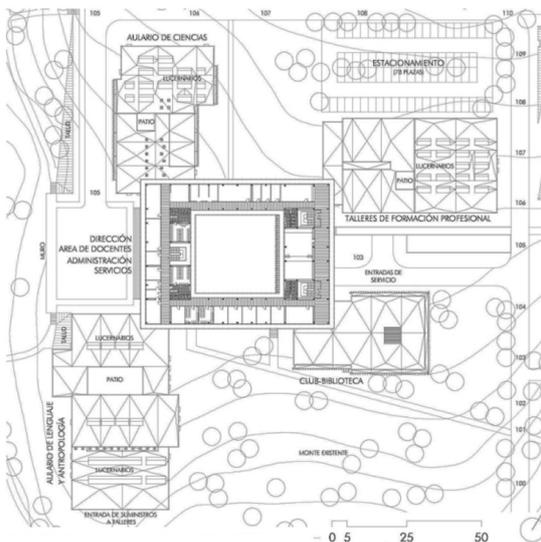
Planta alta del edificio de Dirección y plantas de cubierta.
